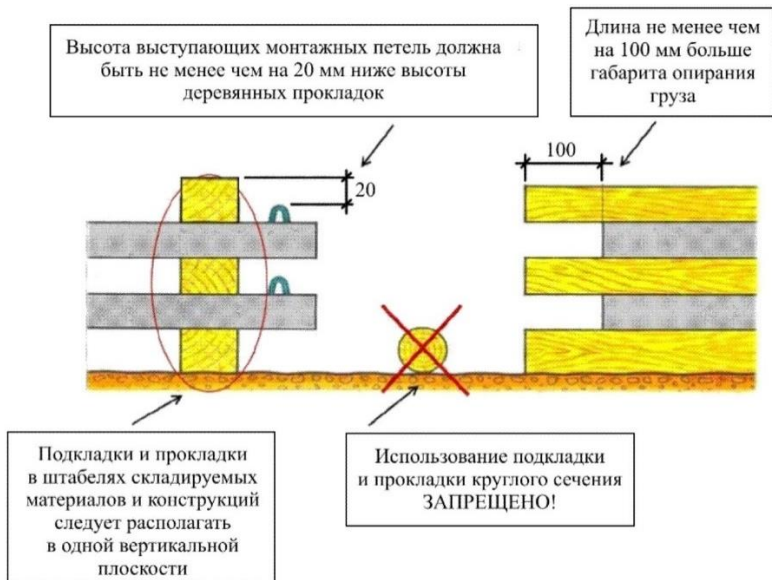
Требования к расположению прокладок и подкладок при складировании конструкций в штабель
